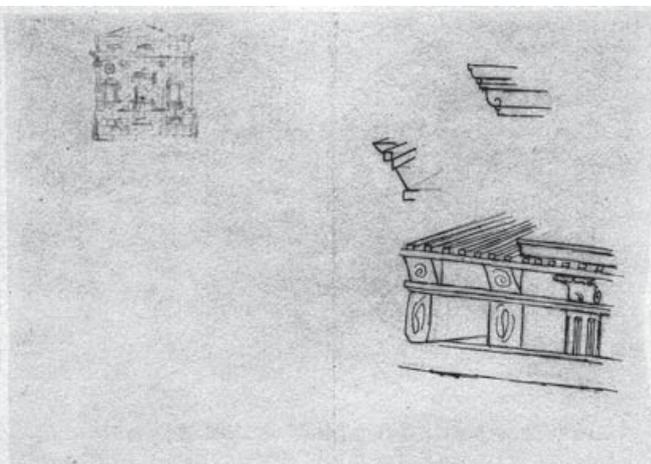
Entablamento dórico y apunte de fachada (¿10.10.1787?). 205x286 mm. Lápiz y tinta con pluma.
